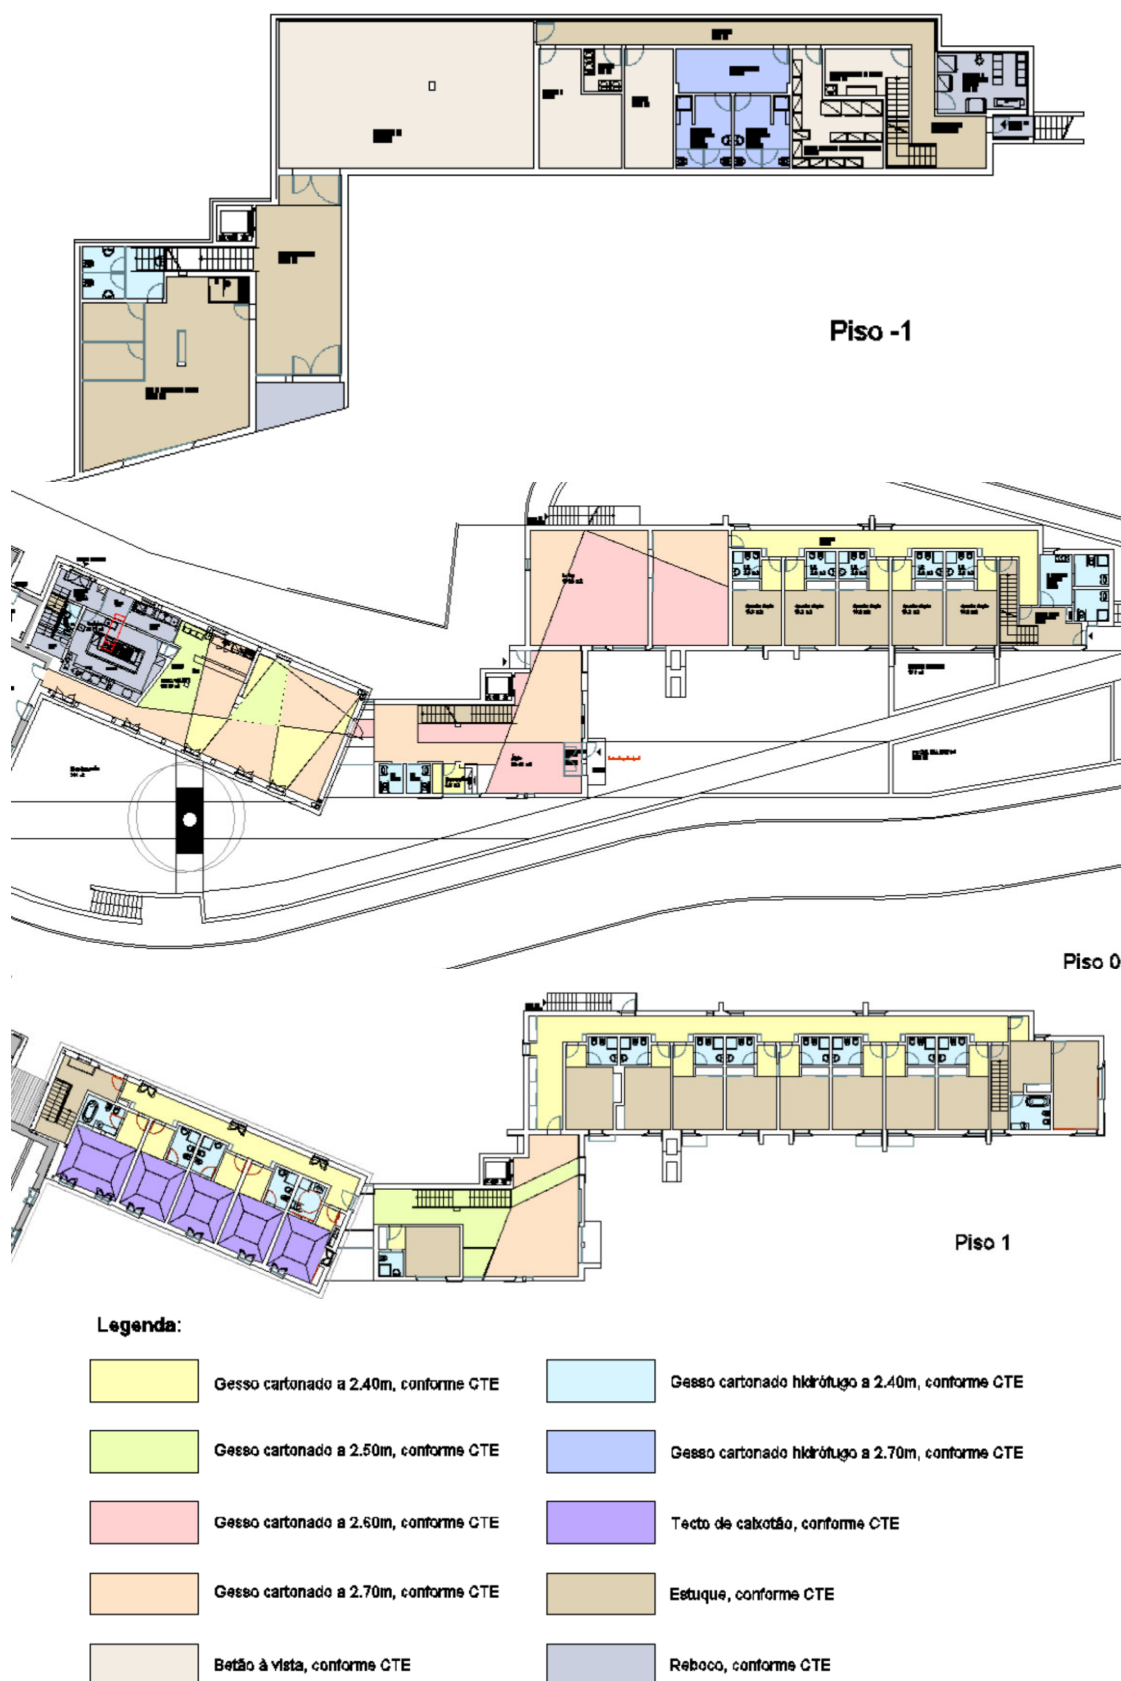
Planta de tetos hotel (s/ escala) [26]
